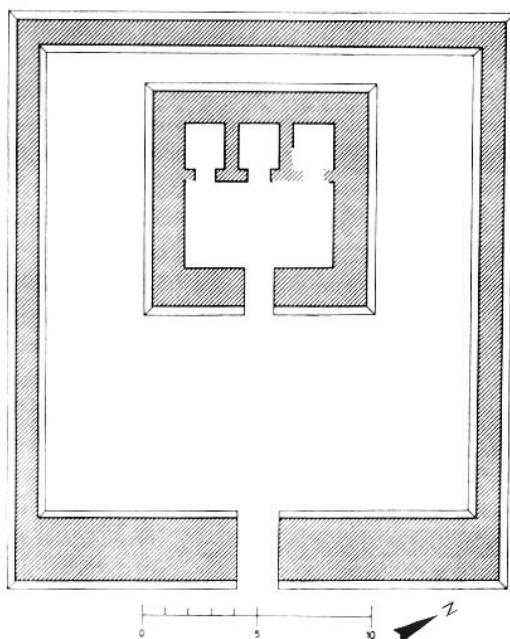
Grundriss Heiligtum/Thotberg
